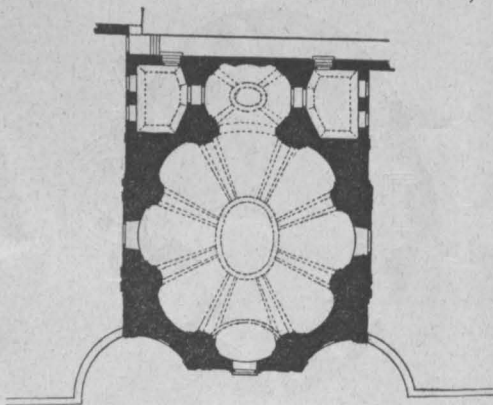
Grundriß der Gardekirche am Rennweg, III. Bez.
